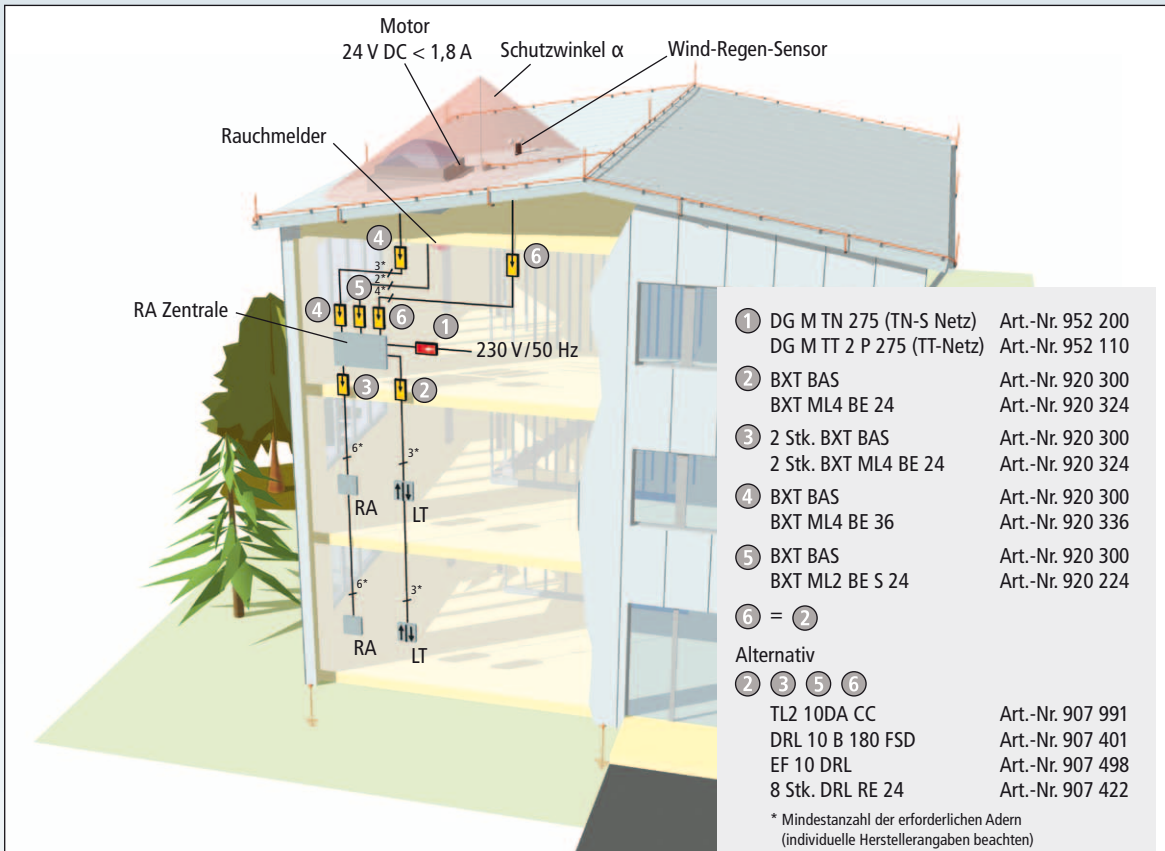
Lichtkuppel im Schutzraum einer Fangstange auf einem metallenen Dach einer baulichen Anlage mit metallener Ableiterstruktur (Stahlskelett, verbundener Stahlbeton oder geerdete Metallfassade)
